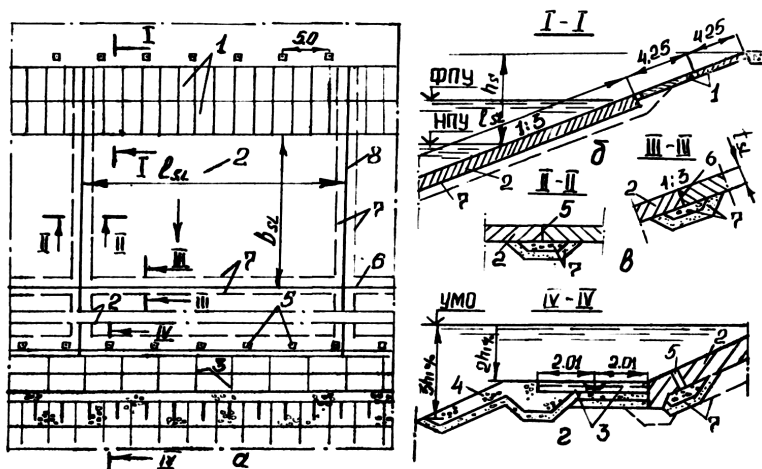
Крепление откоса монолитными железобетонными плитами: а – план крепления; б, в – верхняя и нижняя части крепления; в – конструкция температурно-осадочных швов; 1, 4 – облегченное покрытие соответственно из сборных плит и камня; 2 – основное монолитное железобетонное покрытие; 3 – гибкий тюфяк из сборных плит; 5 – дренажные отверстия; 6, 8 – температурно-осадочные швы; 7 – ленточный дренаж
